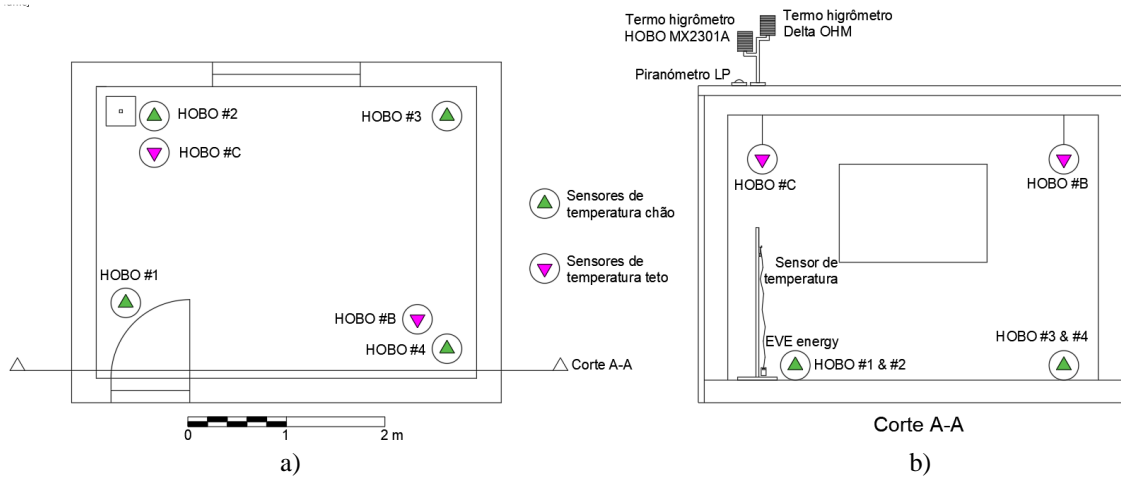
Distribuição da instrumentação na célula de teste: a) Vista em planta; b) Vista em corte.
